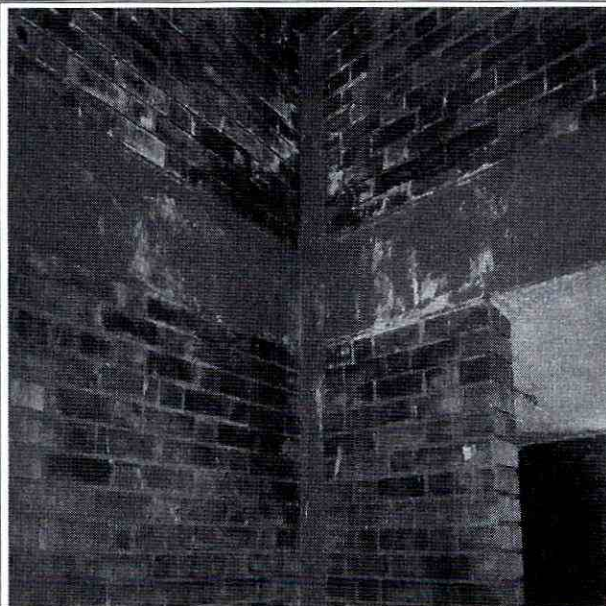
Humedades en el sistema estructural de pórticos en concreto
